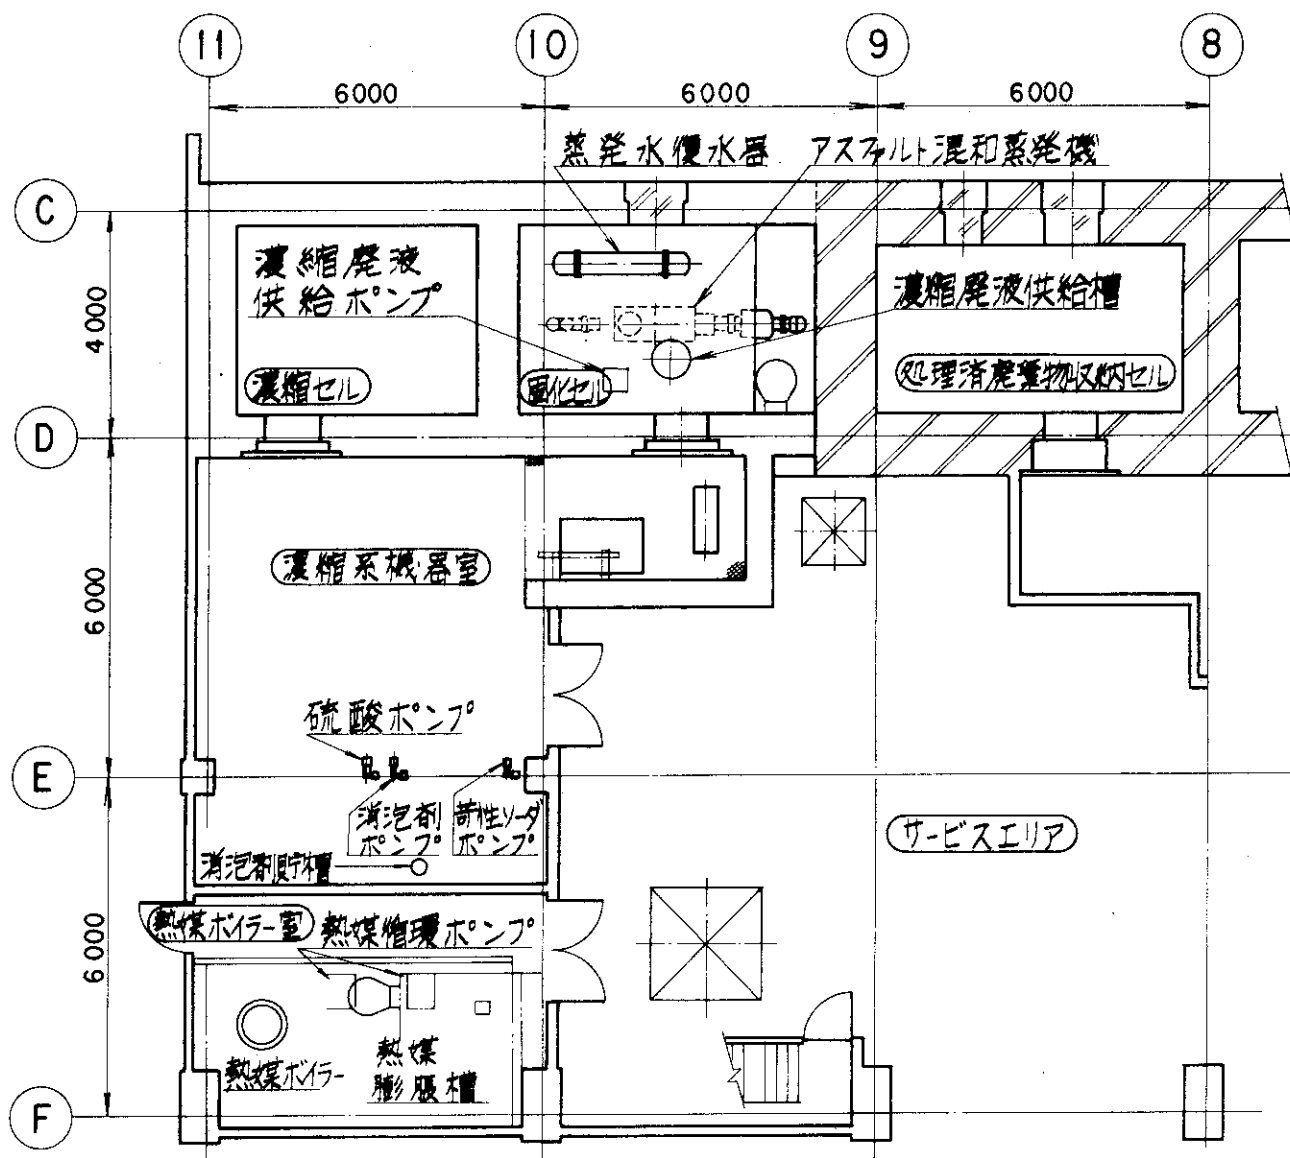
アスファルト固化処理設備機器配置図 (その 2) 1 階平面
